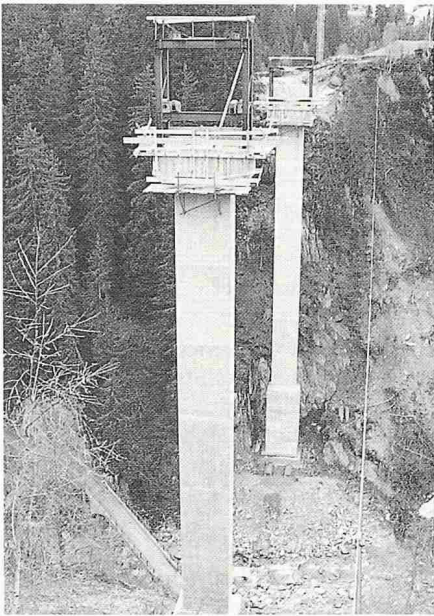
Betonpfeiler mit aufgebauten Hilfskonstruktionen
